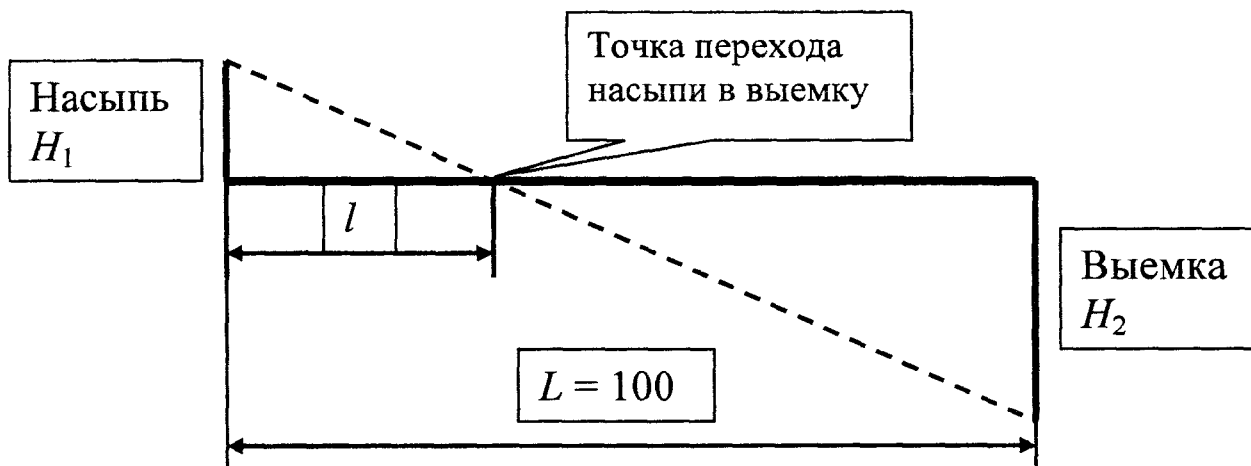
Расчетная схема определения перехода насыпи в выемку
